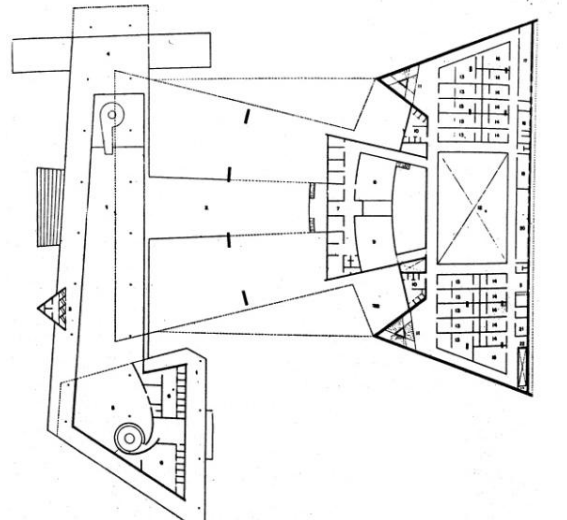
Planta baixa do Teatro Castro Alves, Salvador, de Bina Fonyat Filho. Fonte: Bruand (2010:218).
